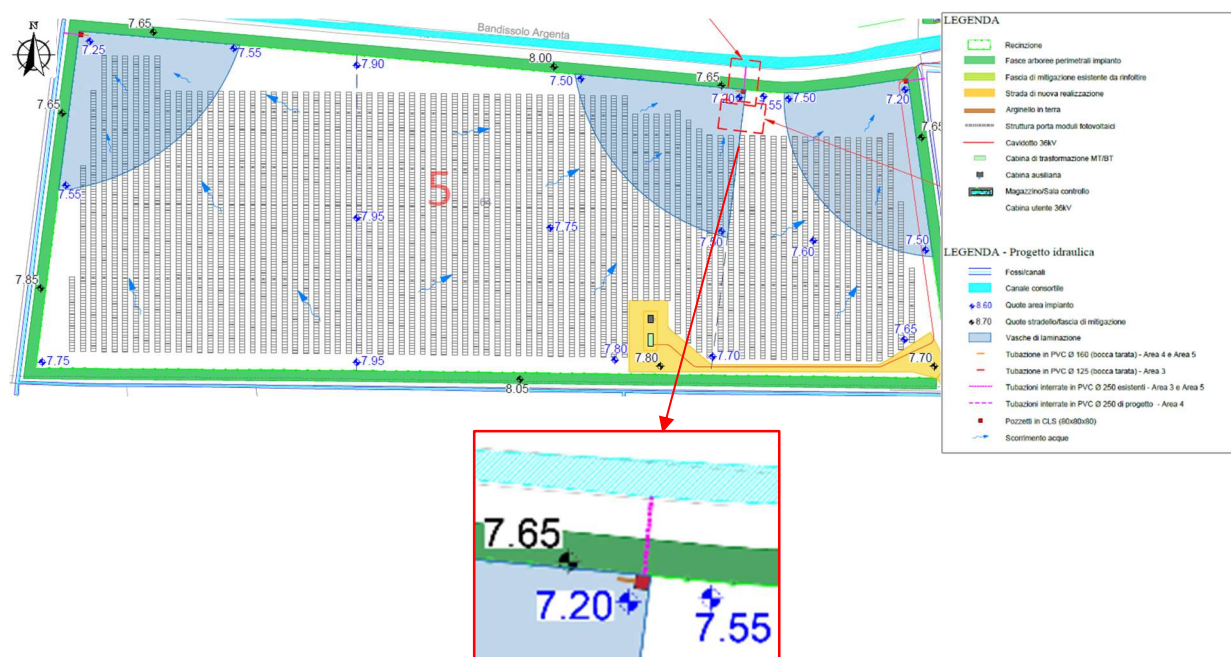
Individuazione vasche di laminazione area 5 (stralcio Tav. 43B)
